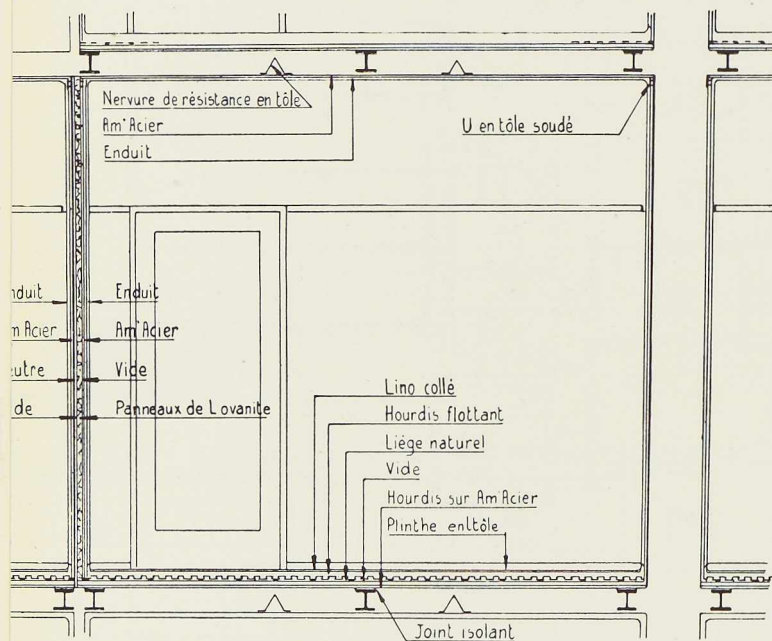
Coupe dans une pièce, montrant la constitution des planchers, des cloisons et du plafond flottant.
